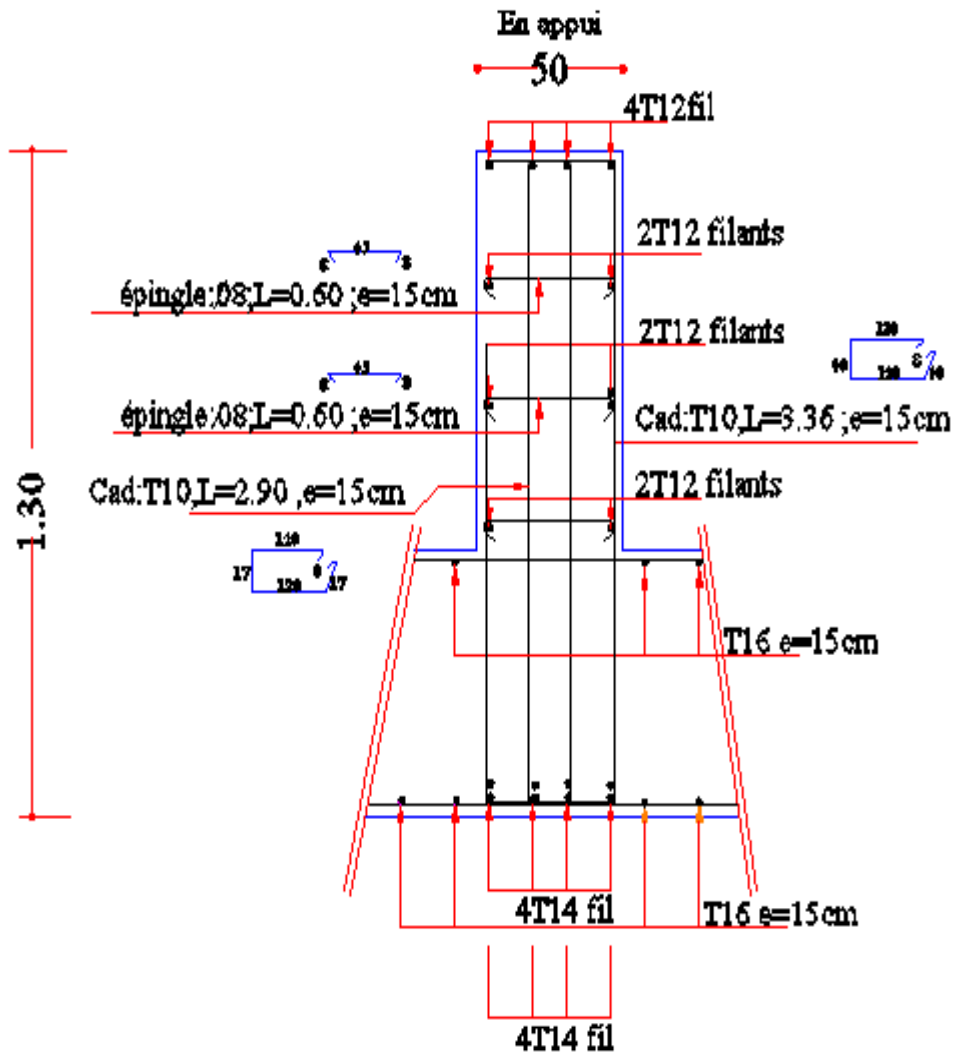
Ferrailage de la nervure en appui et la dalle du radie
